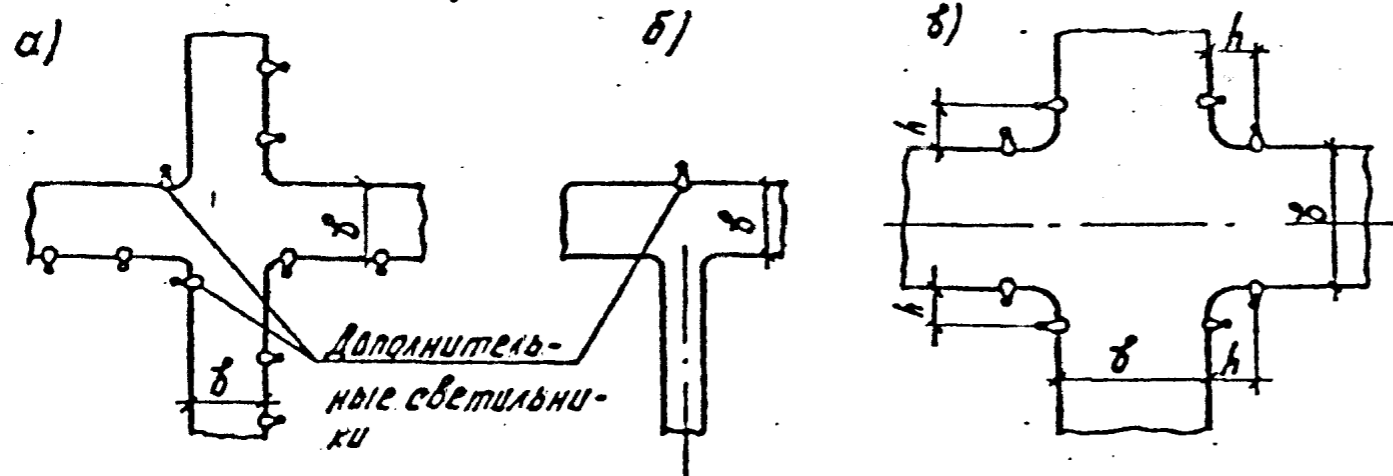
Схемы размещения светильников на пересечениях в одном уровне (h - высота светильника, b - ширина дороги)
